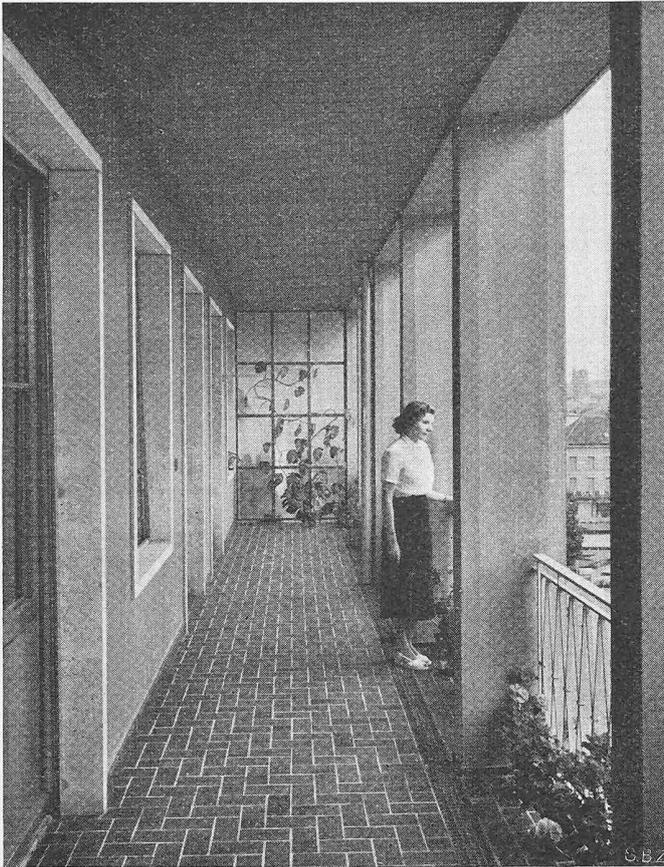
Durchgehende Terrasse im 4. Stock des Baues 2
